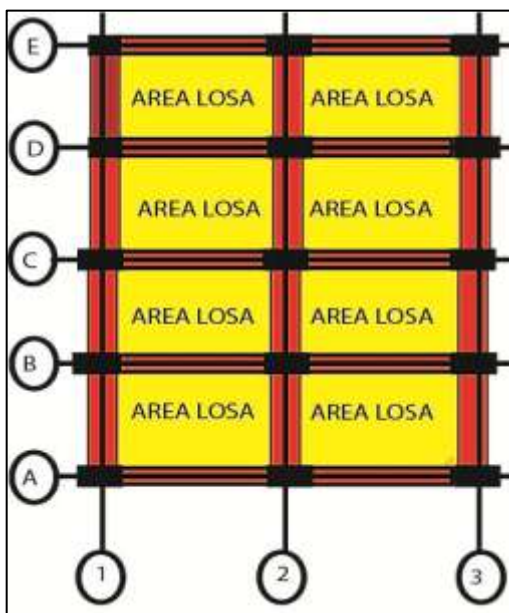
Plano De área losa; Fuente: [Grupo investigador]
